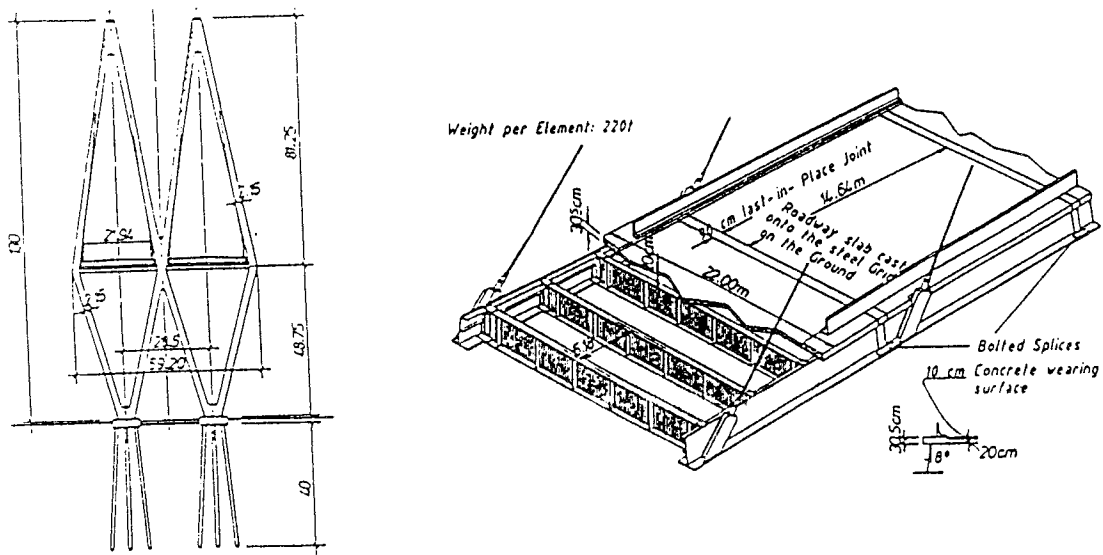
Propuesta puente mixto en Baytown. Texas (Diseño Leonhardt, Andra and Partners).
